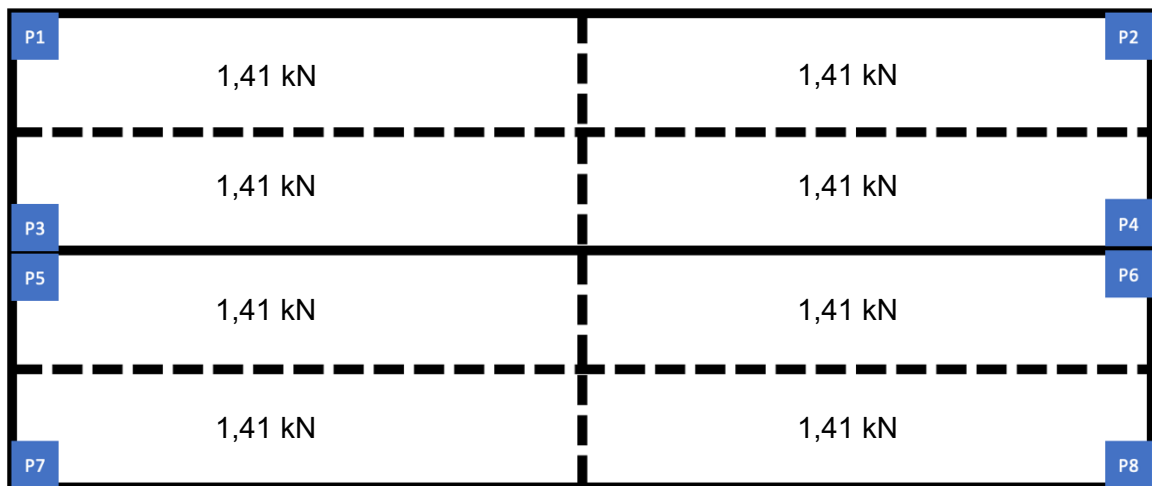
Distribució de les càrregues degudes al pes de l'aïllament del sostre – planta baixa
